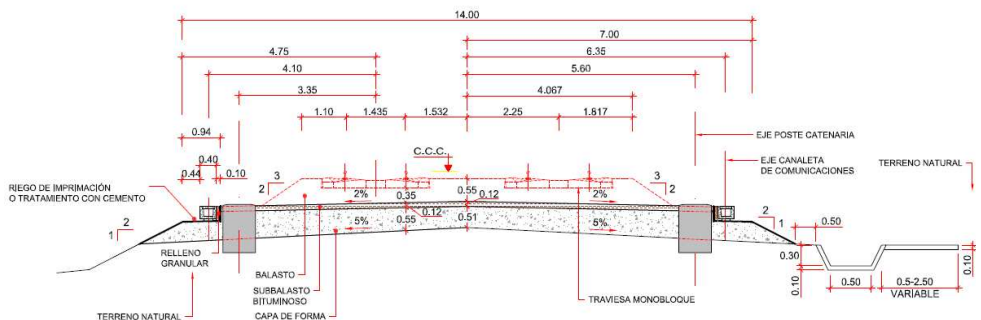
Sección tipo de canaleta elevada y enrasada (Fuente: elaboración propia).
